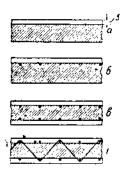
Различные способы армирования бетонной плиты. (Штриховка на рисунках не доведена, как то следует, до верха и низа плиты.)
